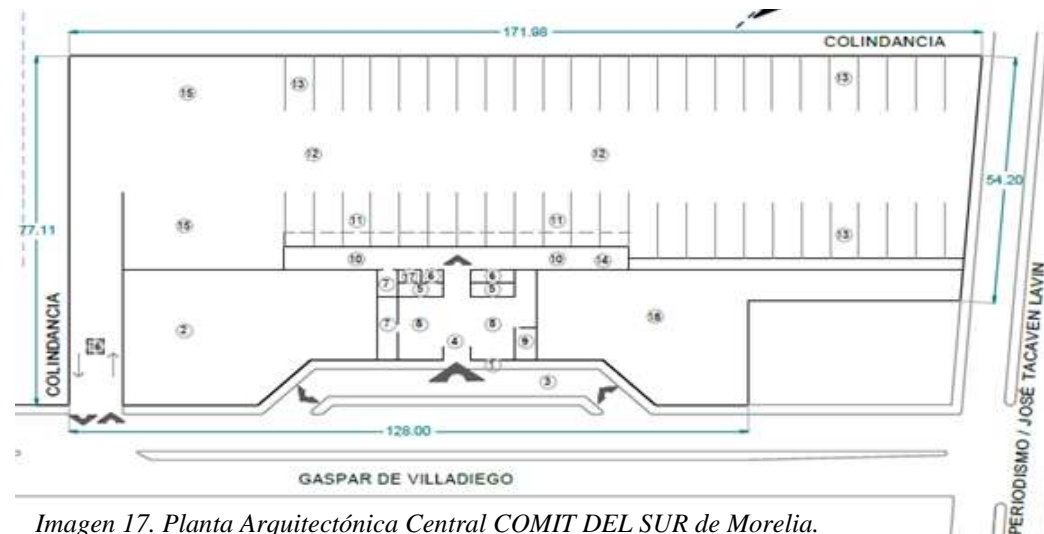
Planta Arquitectónica Central COMIT DEL SUR de Morelia.
